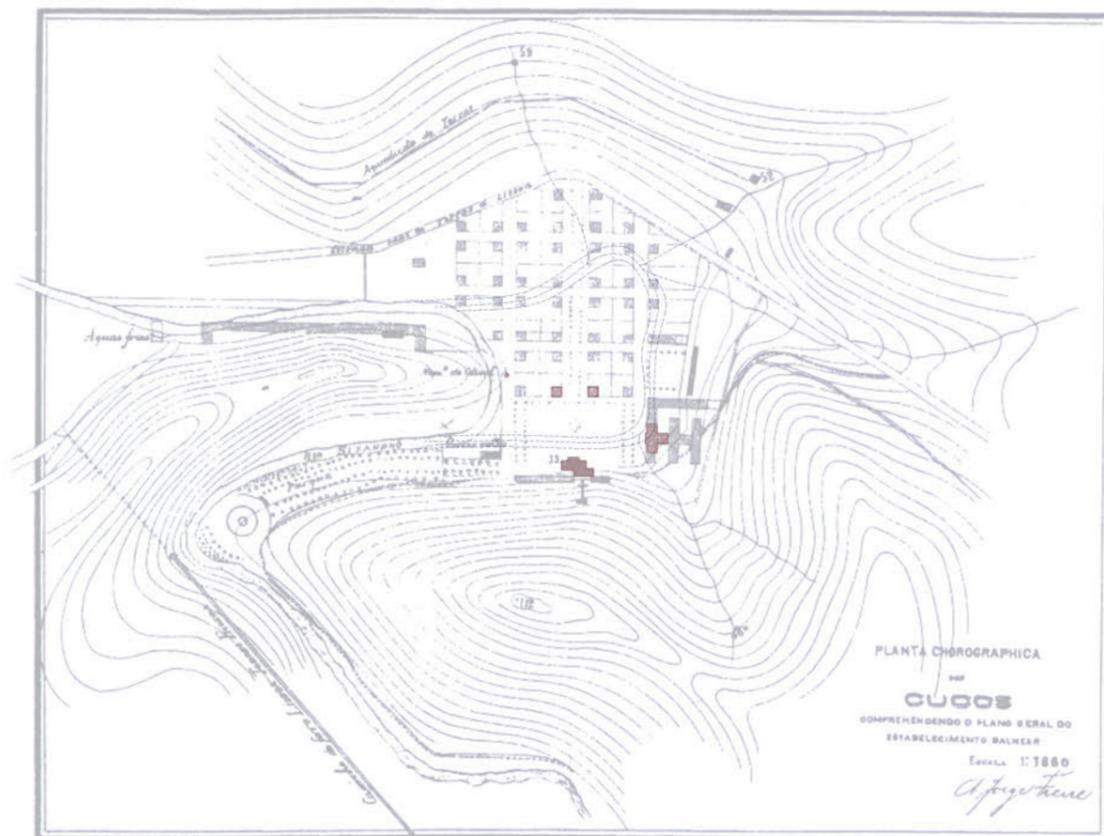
| Planta Chorográfica do Plano geral para o Vale dos Cucos com sobreposição do edificado construído
